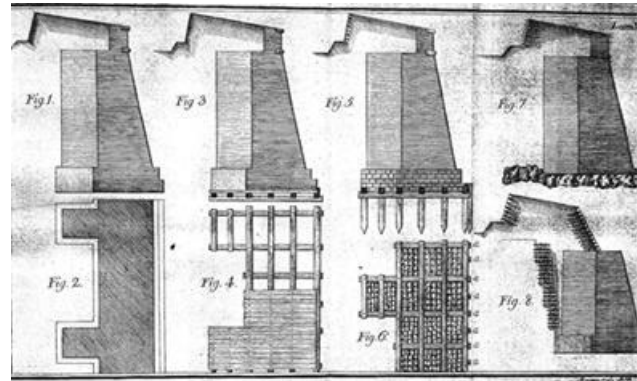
Construcción de cimientos. Según el tipo de suelo, figuras 5 y 6 cimentación con pilotes de madera y embargado. Müller John. Tratado de Fortificación
